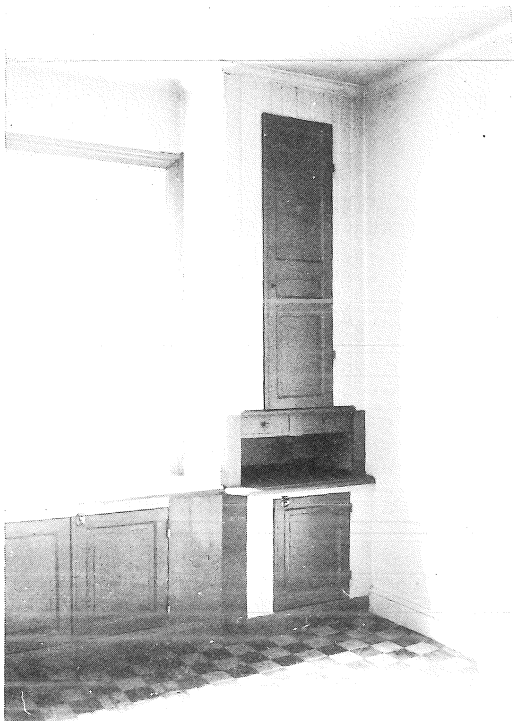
Intressanta skafferiskåp kunde ha sparats om kökets ursprungliga disposition bibehållits
